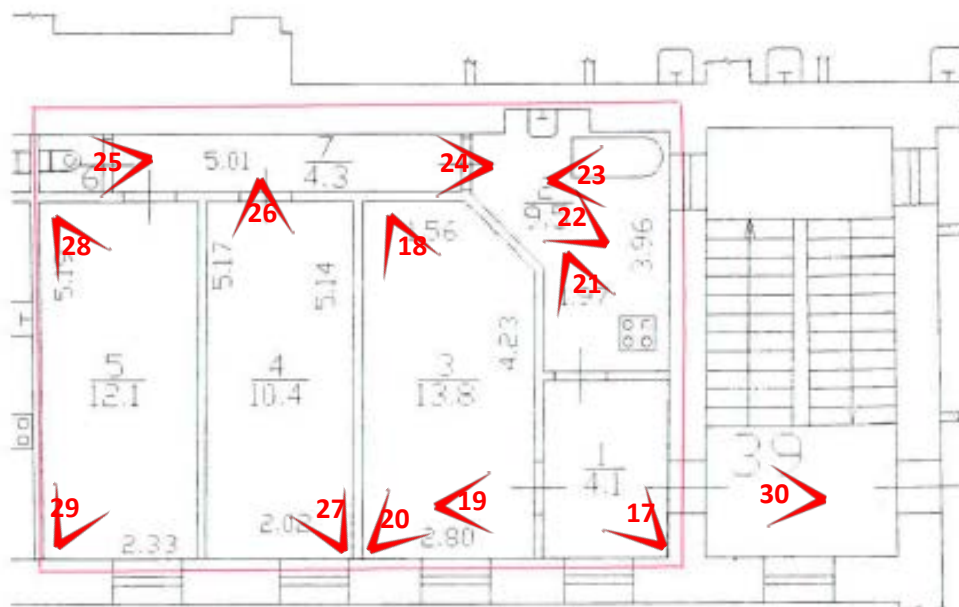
Схема фотофиксации на фрагменте плана 4 этажа
